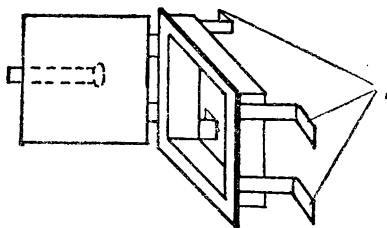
Prevederea ușițelor cu ancore (1) în vederea montajului.
